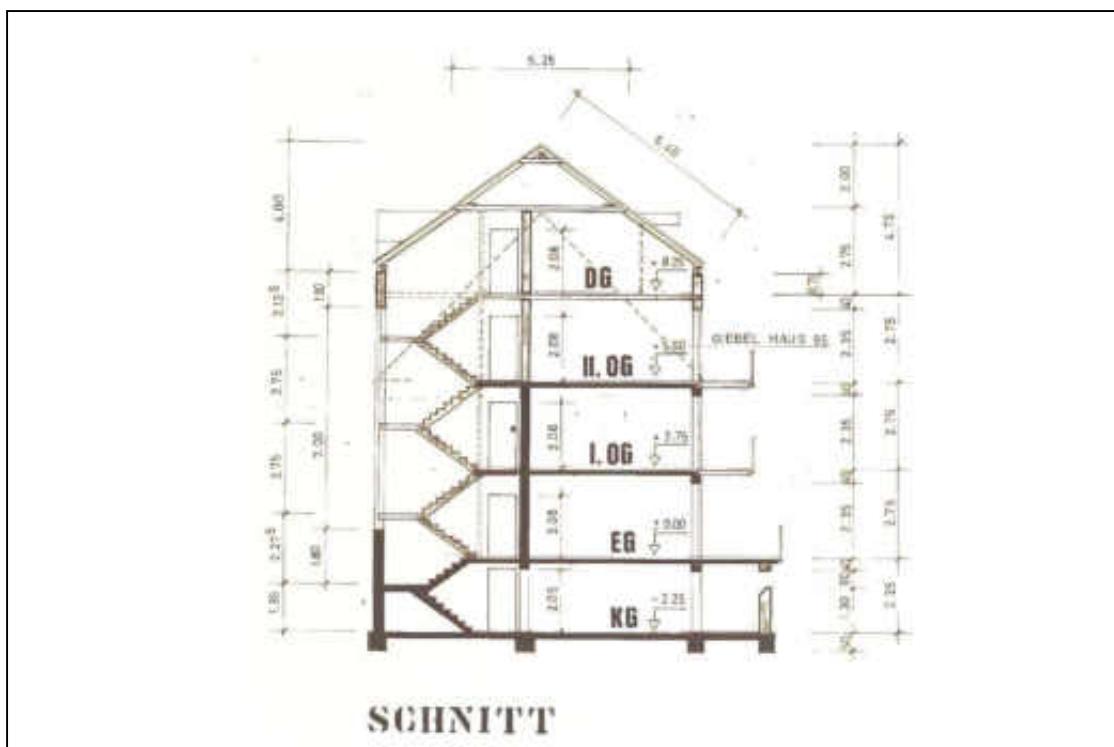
Schnitt durch die bauliche Anlage mit dem Gebäudetyp G fotografiert am 17.06.2025
